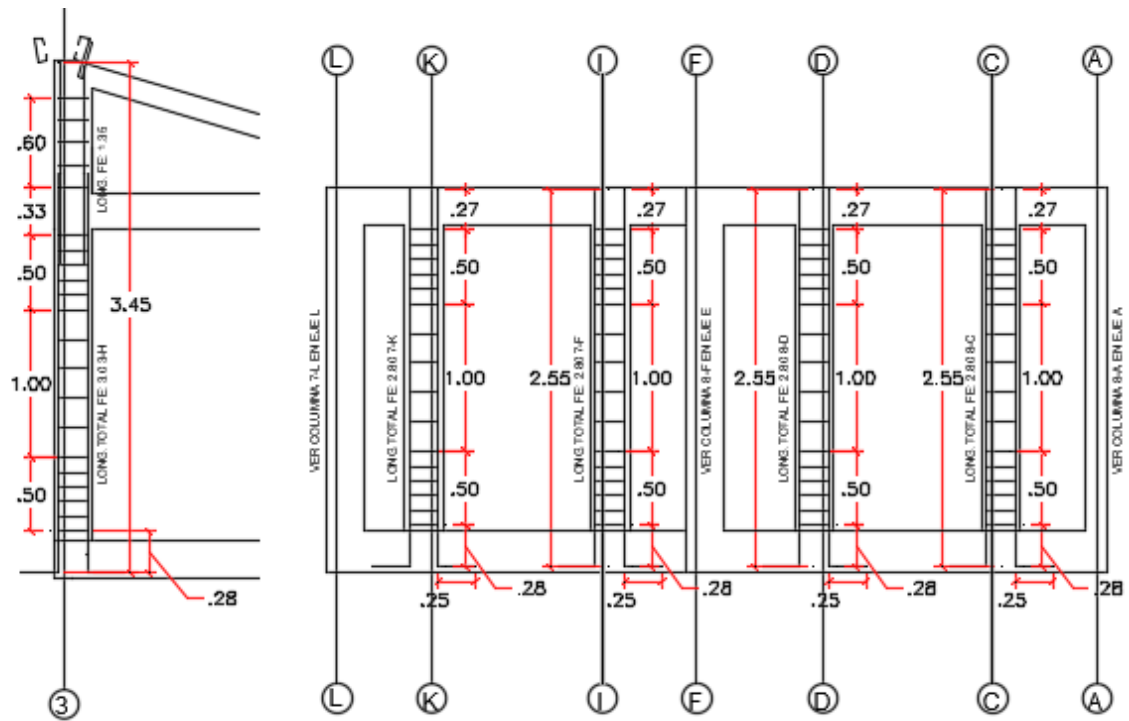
Refuerzos eje H y columnas eje 7 y 8
